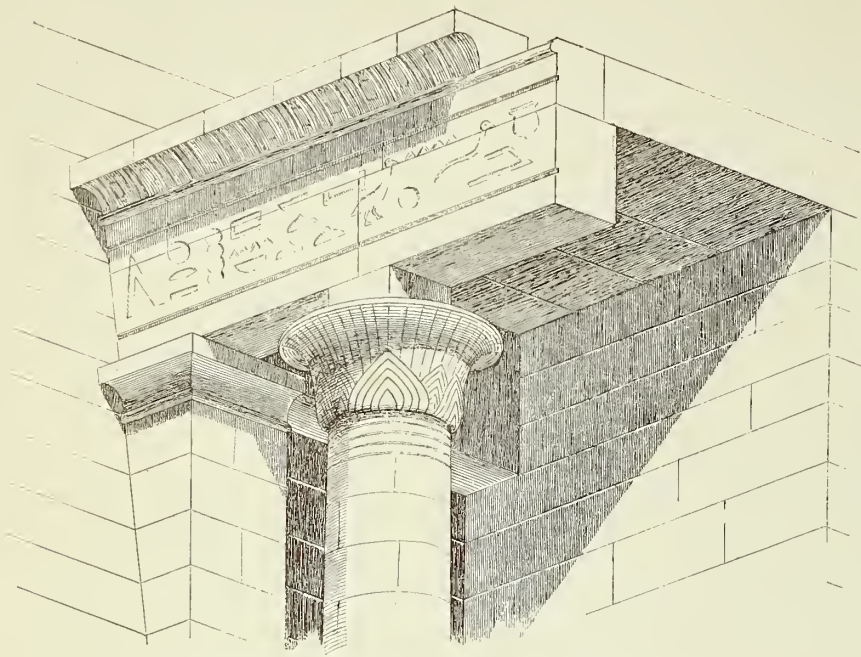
DISPOSICIÓN DE ANTA Y COLUMNA, EN MEDINET-ABU
